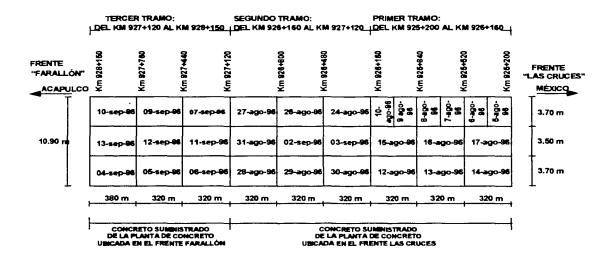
Croquis de colocación de concreto en el piso del túnel.
